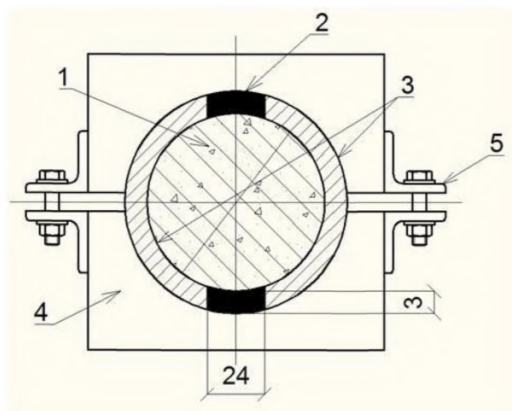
Схема устройства подливки вдоль керна по двум образующим с помощью кондуктора:
